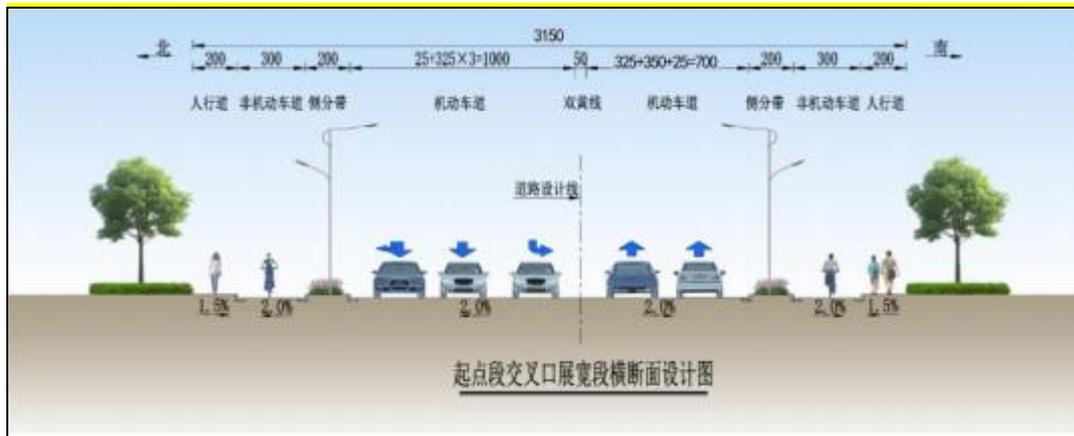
起点路基段横断面图（交叉口展宽）
